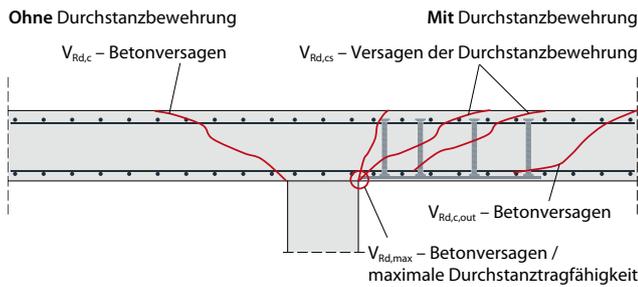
Versagensformen im Bereich ohne und mit Durchstanzbewehrung
